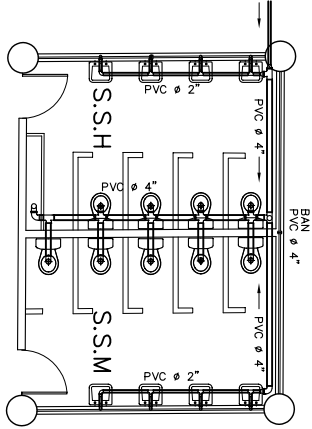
Planta de instalación de drenajes sótanos 2, 3 y 4
